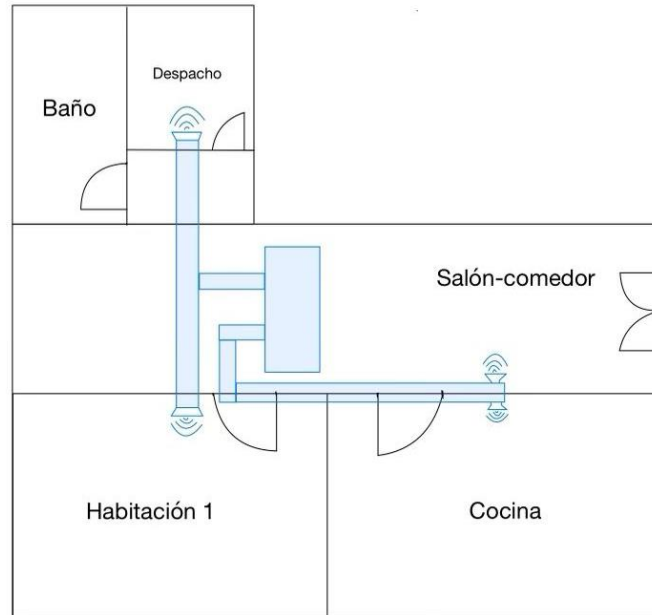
Simplificación distribución de fan-coils planta baja. Fuente: Elaboración propia (2023).
